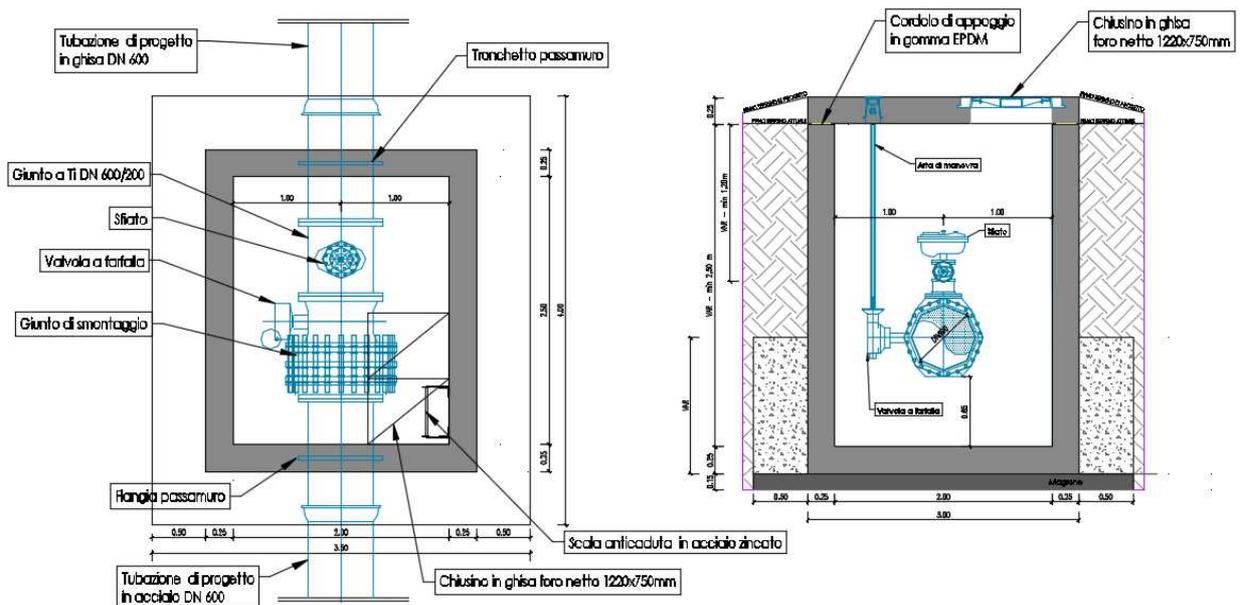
Pozzetti di sfiato – Pianta e sezione
